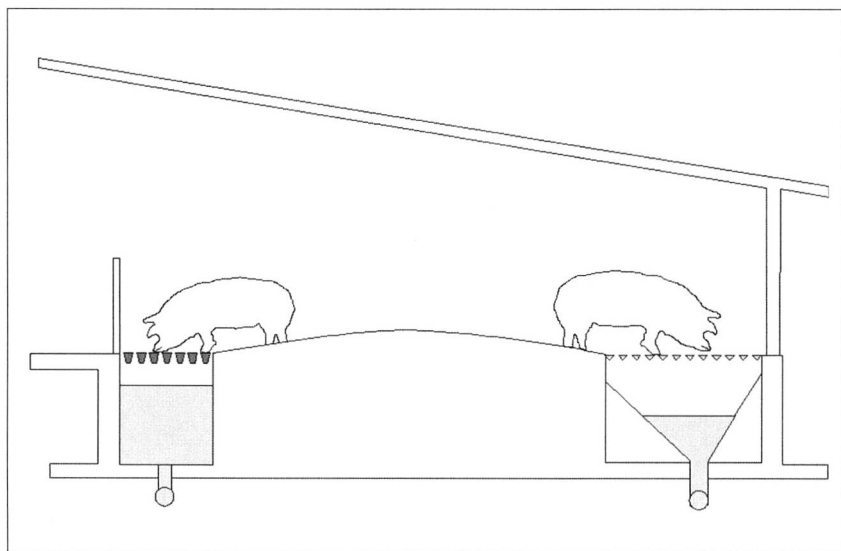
Soluzione con pavimentazione parzialmente fessurata
